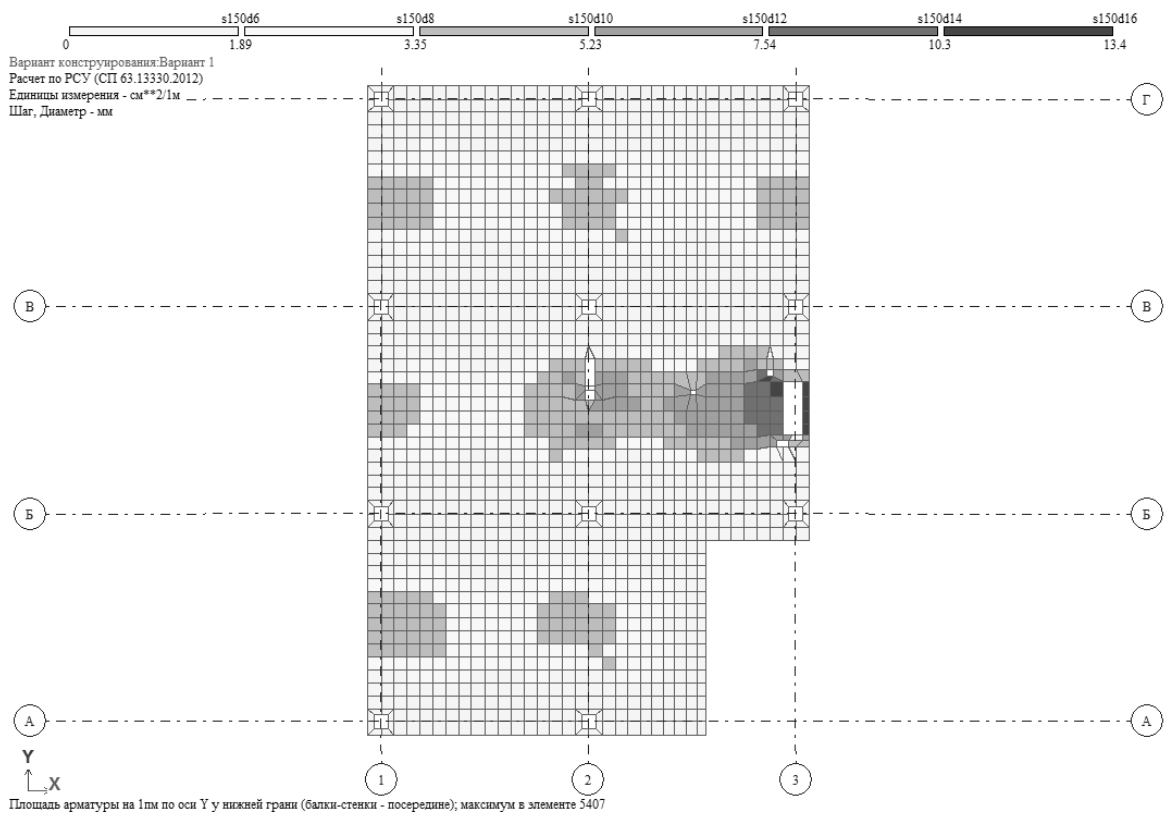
Армирование плит перекрытия по оси Y у нижней грани
